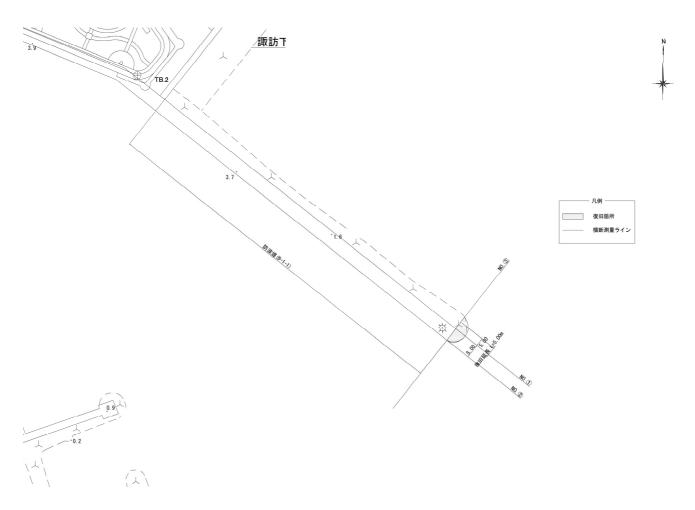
No.6 諏訪下地区_防波堤の平面図(復旧後)
